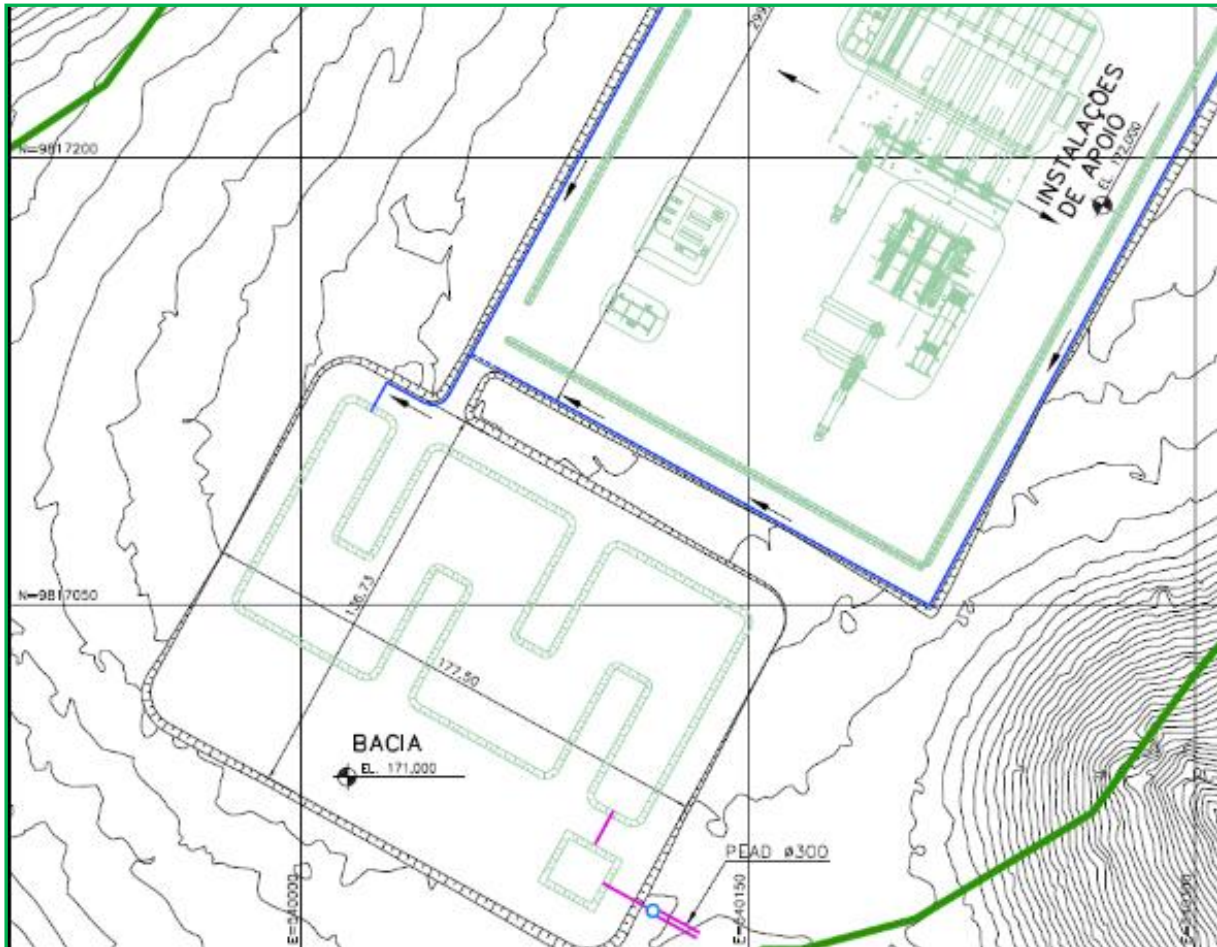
Detalhe da bacia de sedimentação que compõe o sistema de coleta e tratamento de efluentes pluviais da área de apoio operacional projetadas para o Platô Rebolado.
